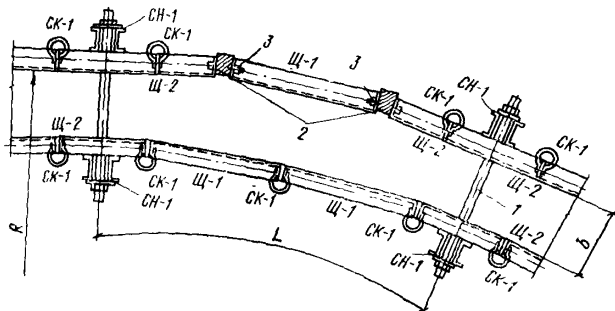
Схема установки стальной опалубки Минмонтажспецстроя для бетонирования круглых резервуаров
